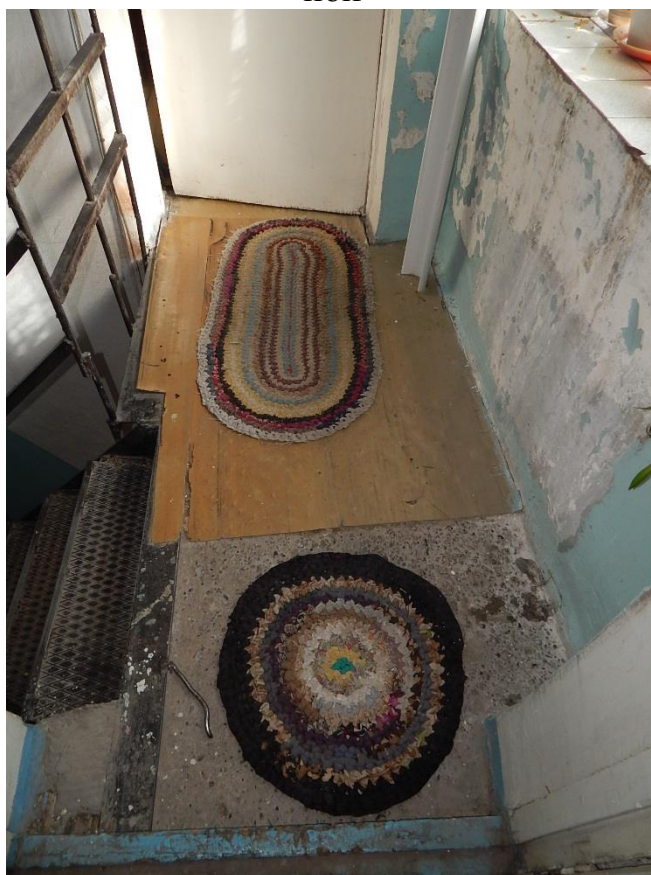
Внешний вид пола с бетонным покрытием на лестничной площадке 2-го этажа
